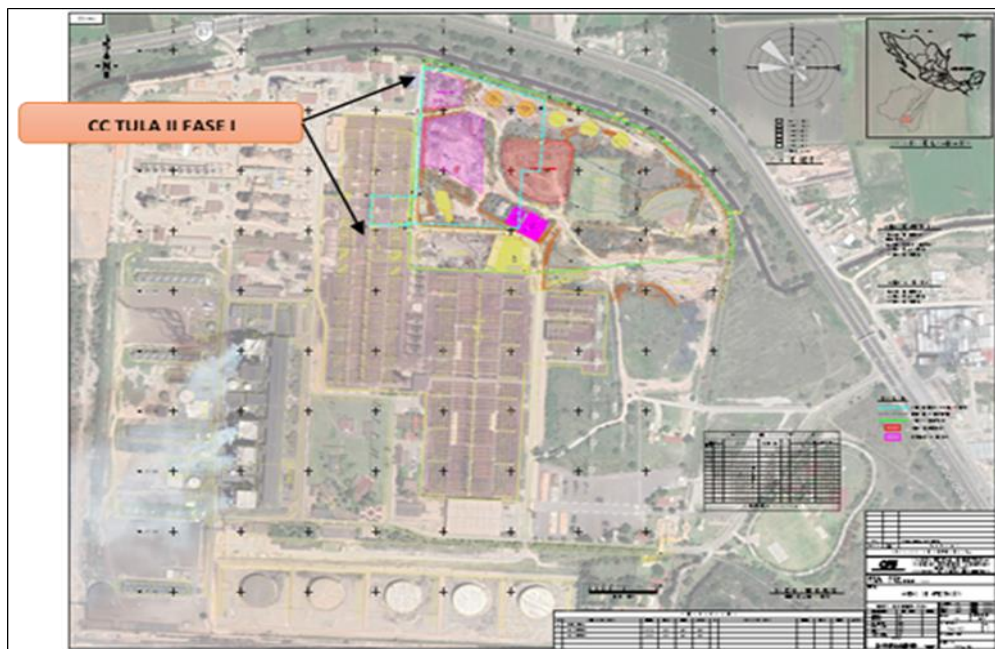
Vista general del sitio del Proyecto
